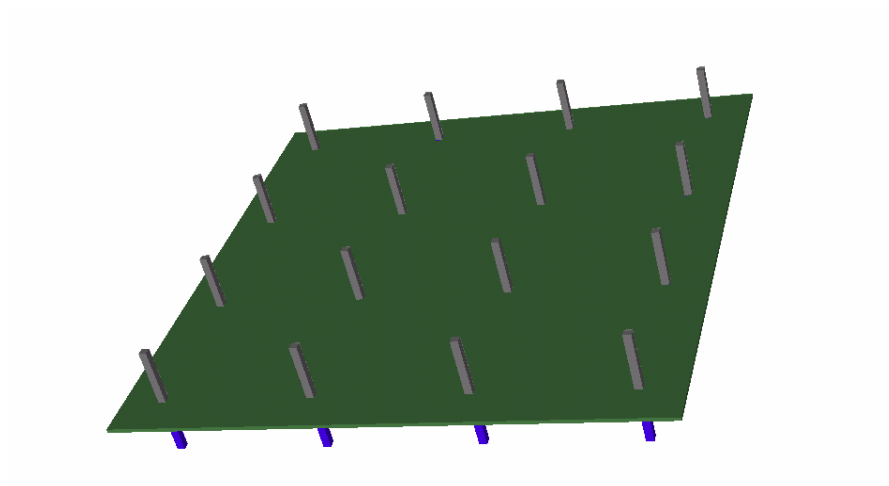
Vista Tridimensional da Estrutural do Exemplo 1
